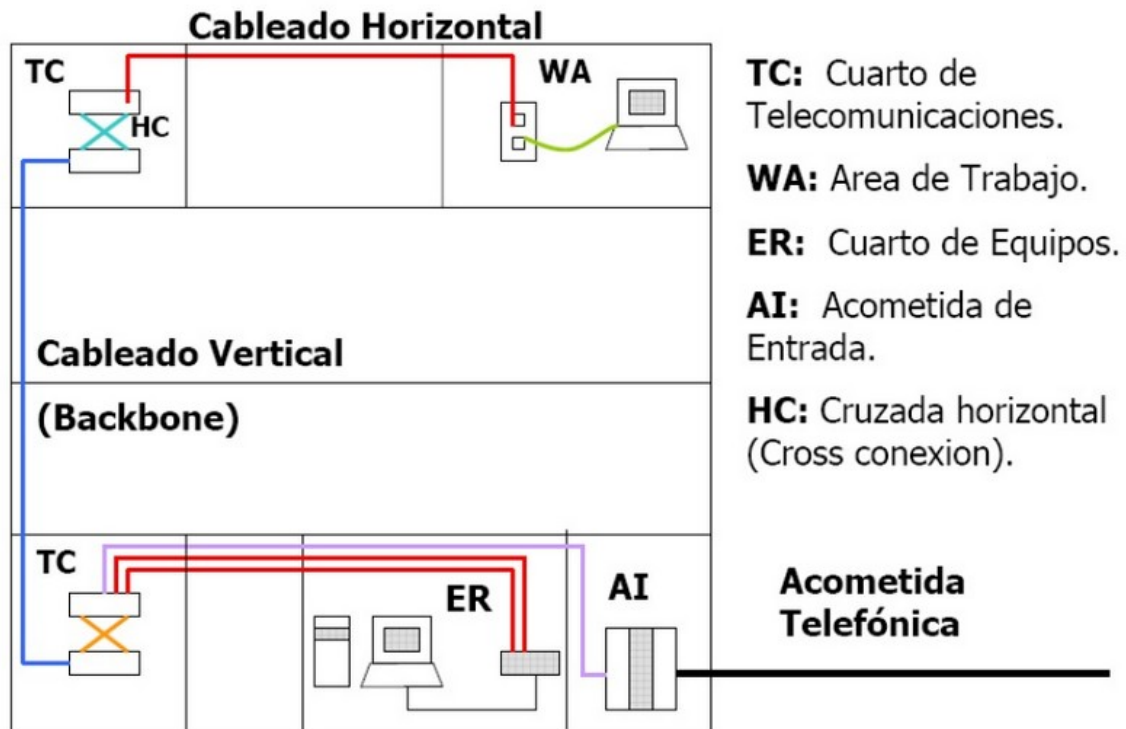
Disposición de las zonas y el recorrido de los cables
